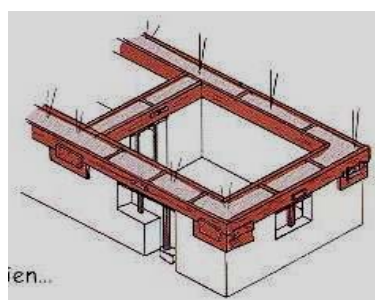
Exemplo do aspeto da viga de coroamento (VIGO e SCHMIDT, 2008).
